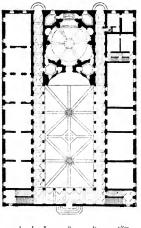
Sapienza zu Rom. Grundriss. (Nach Gurlitt.)
